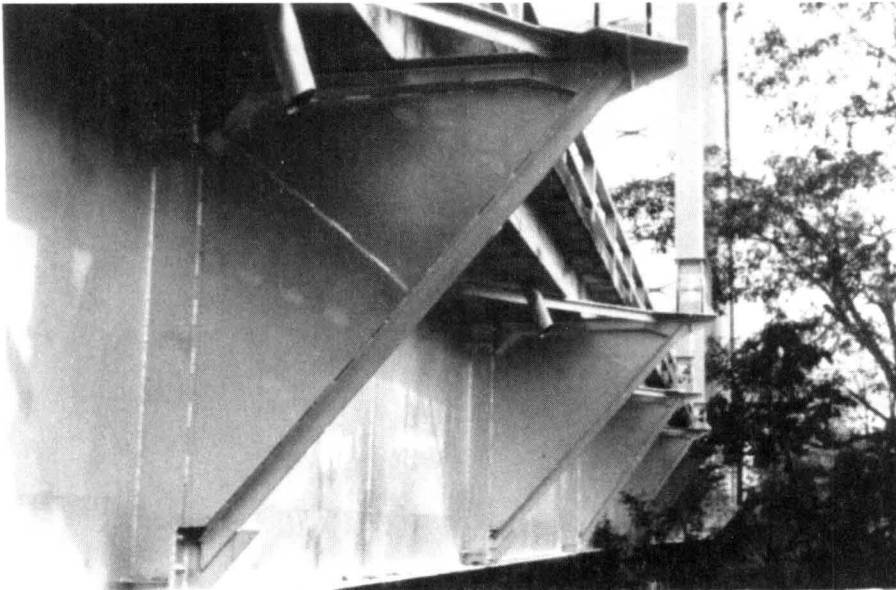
Puente del Opón. Refuerzo de la diagonal exterior de las armaduras transversales.
